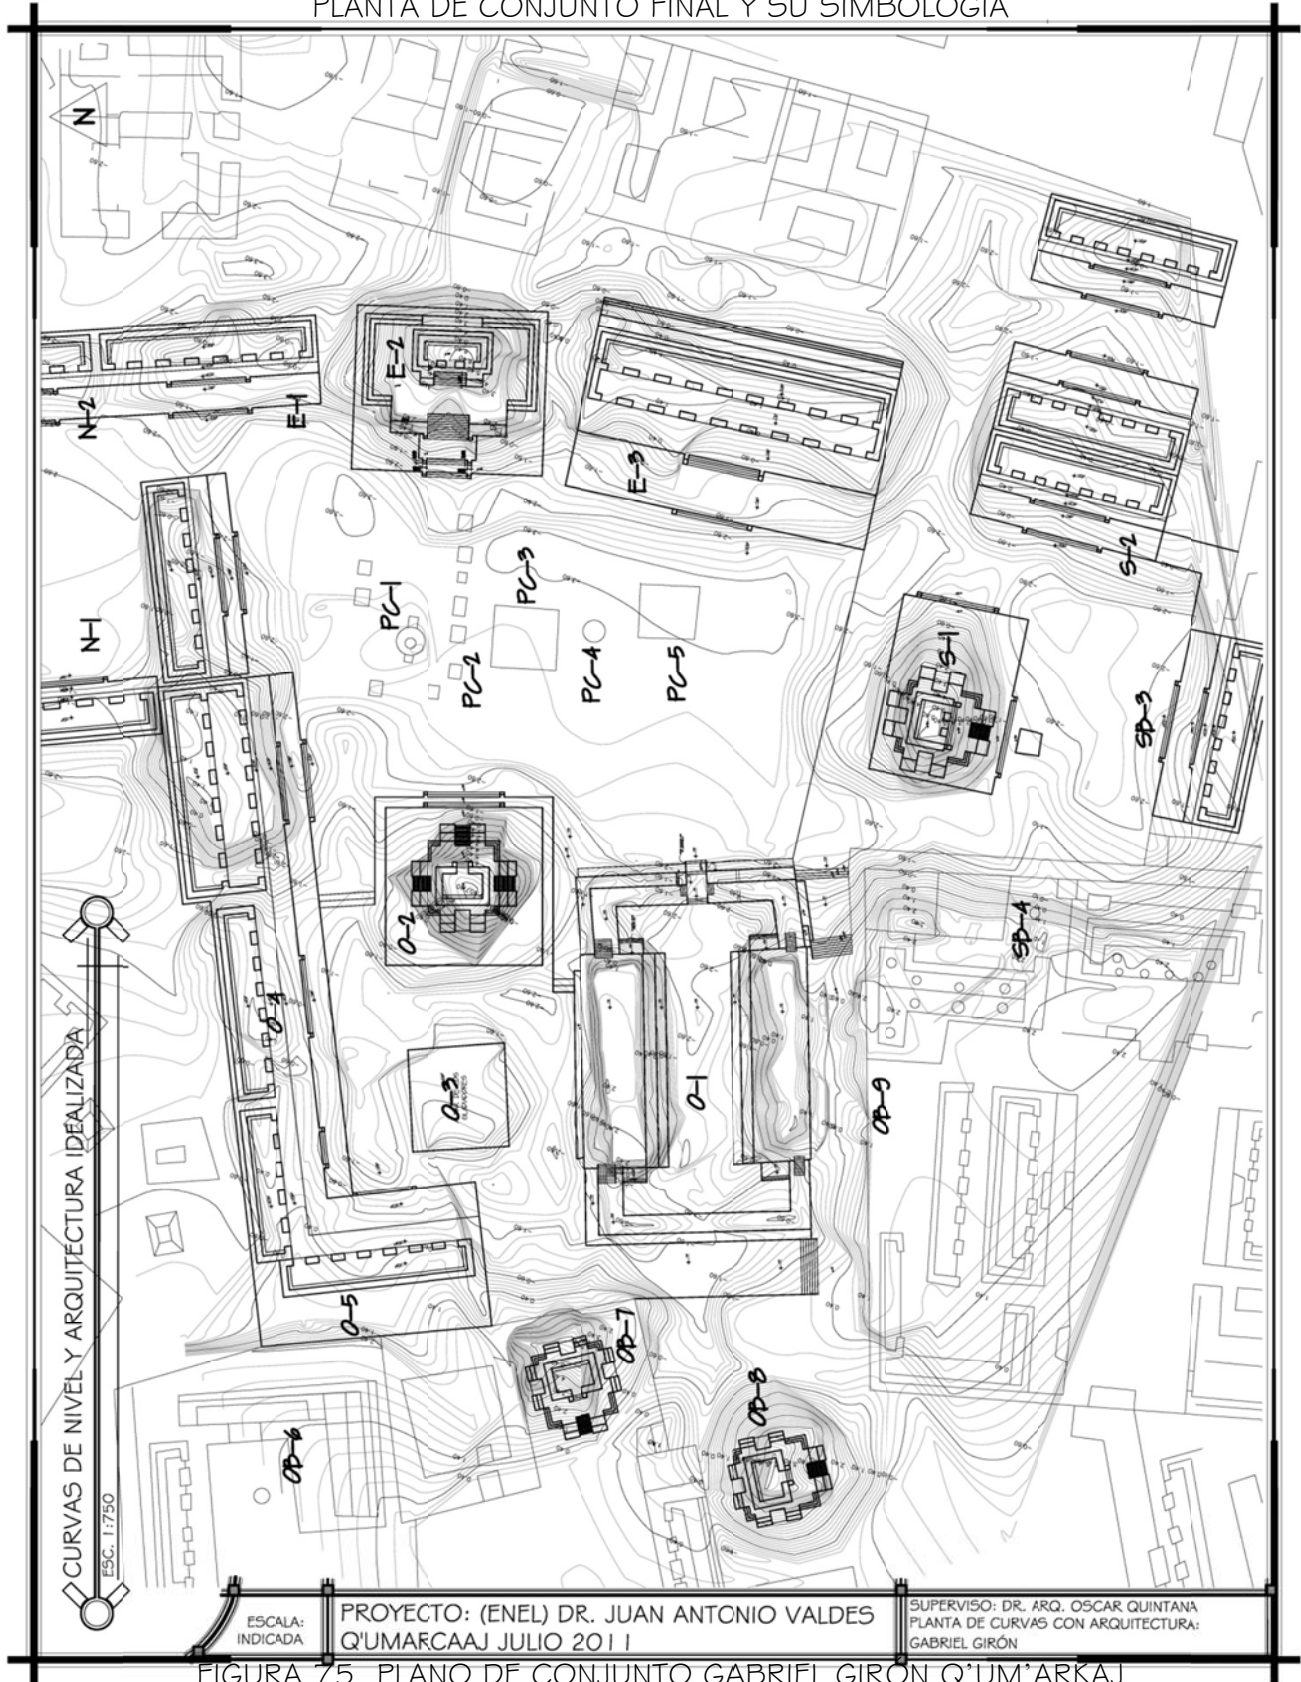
, PLANO DE CONJUNTO GABRIEL GIRÓN Q'UM'ARKAJ
